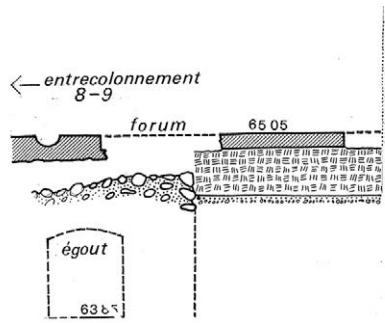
Coupe sur caniveau, entre les bases 8 et 9 (G. Hallier).
